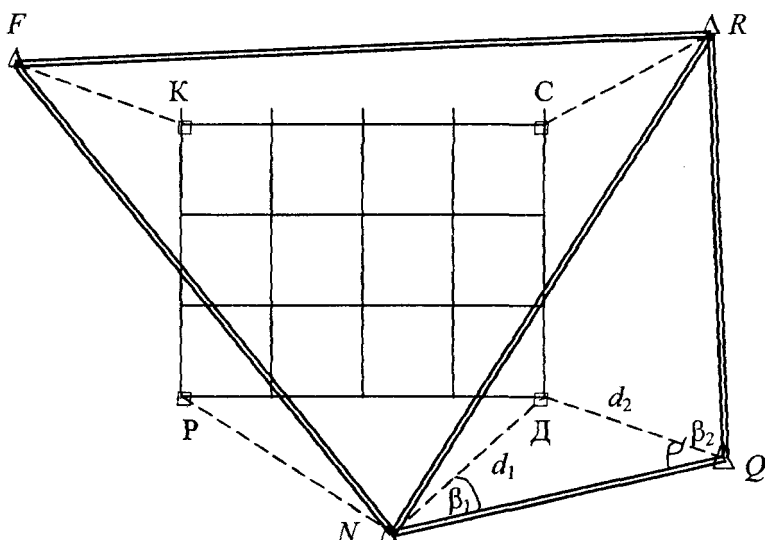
Одна из схем выноса в натуру проекта строительной сетки
